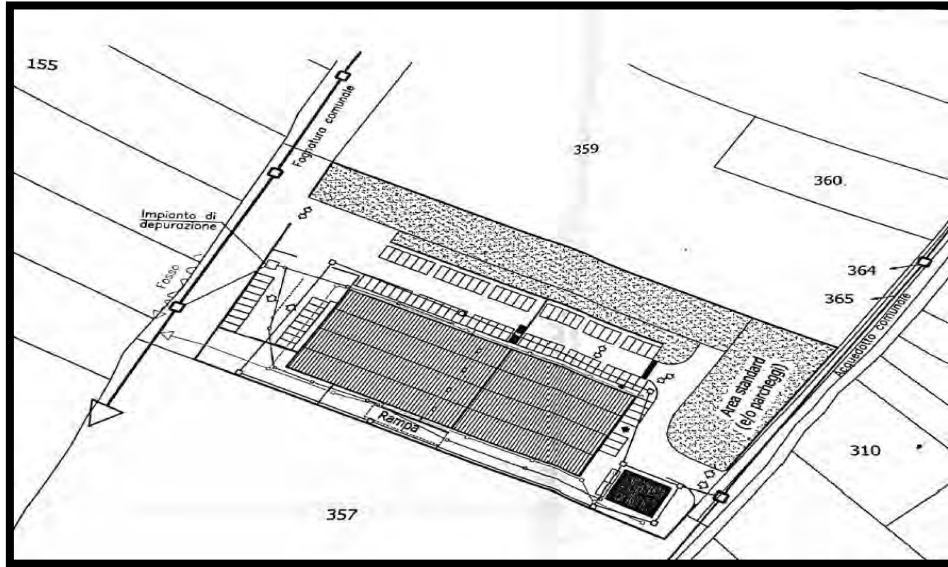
Pianta sistemazione esterna allegata alla DIA n. 8751 del 05/12/2006
